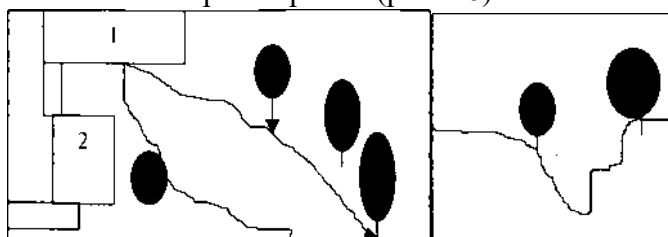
Схема предполагаемого размещения дома: 1 — первоначальный проект, 2 — окончательная площадка размещения
